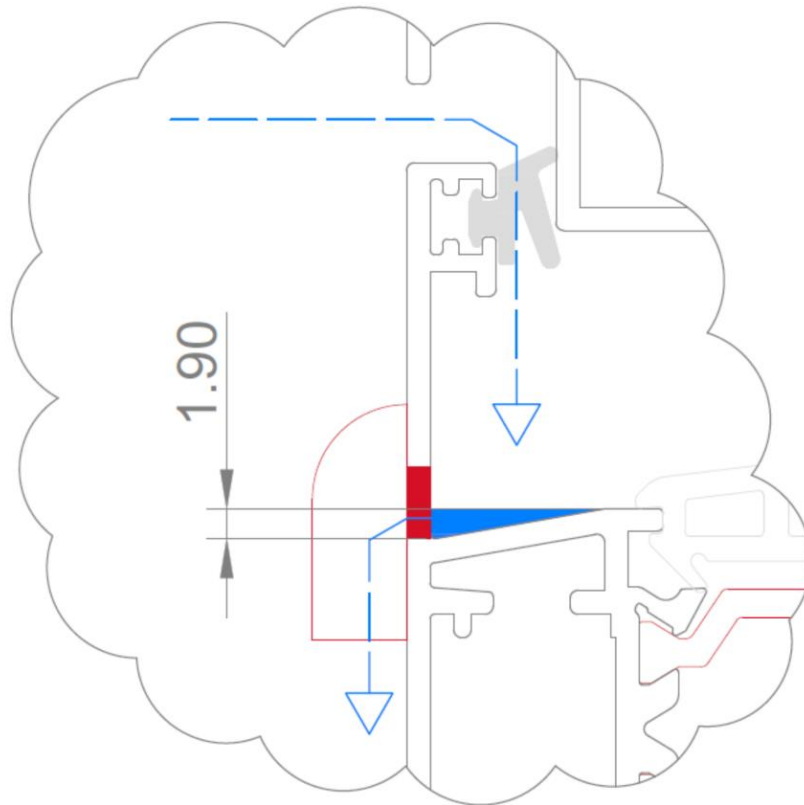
Detalhe do canal de drenagem do aro fixo (a vermelho o rasgo de drenagem e a azul a representação da secção do canal de drenagem).
